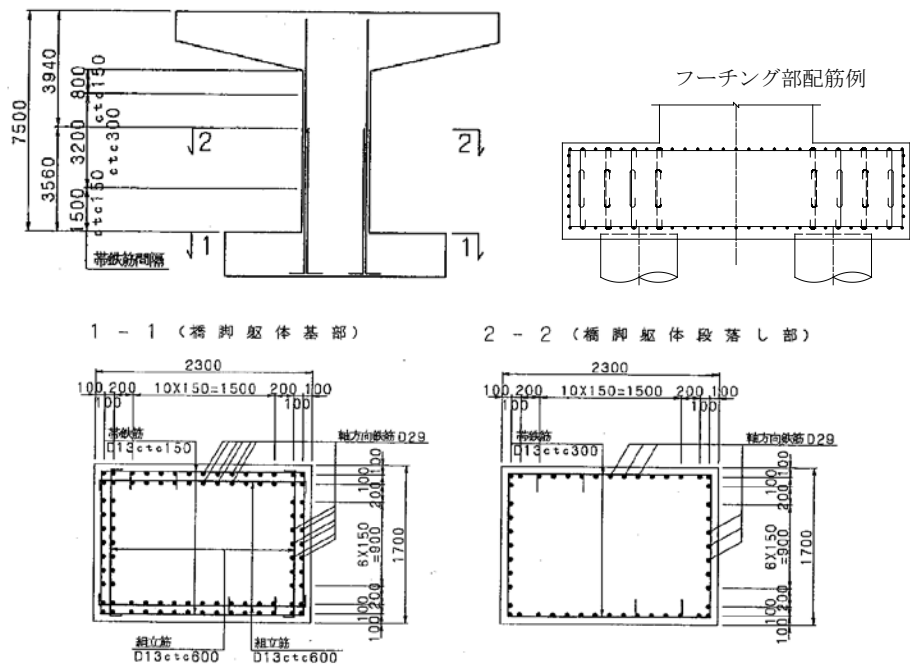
張出し式橋脚の柱部配筋の例 2.10)
